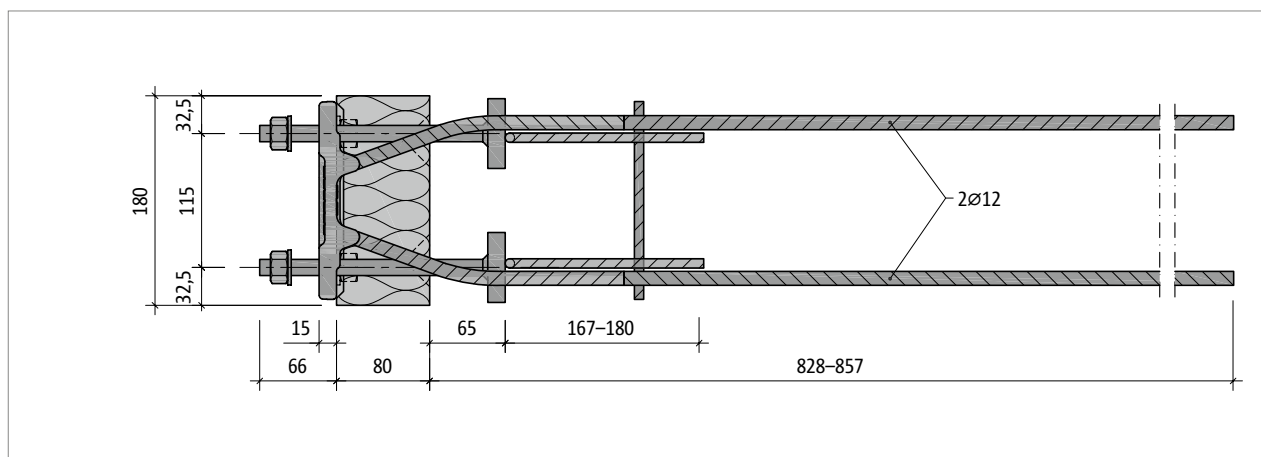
Schöck Isokorb® T type SQ-V3 : plan de base
